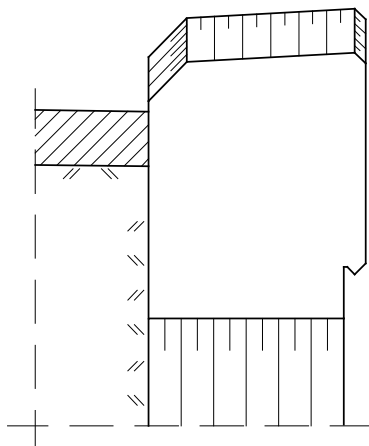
Kantdrager for gangbru (mål i mm)
